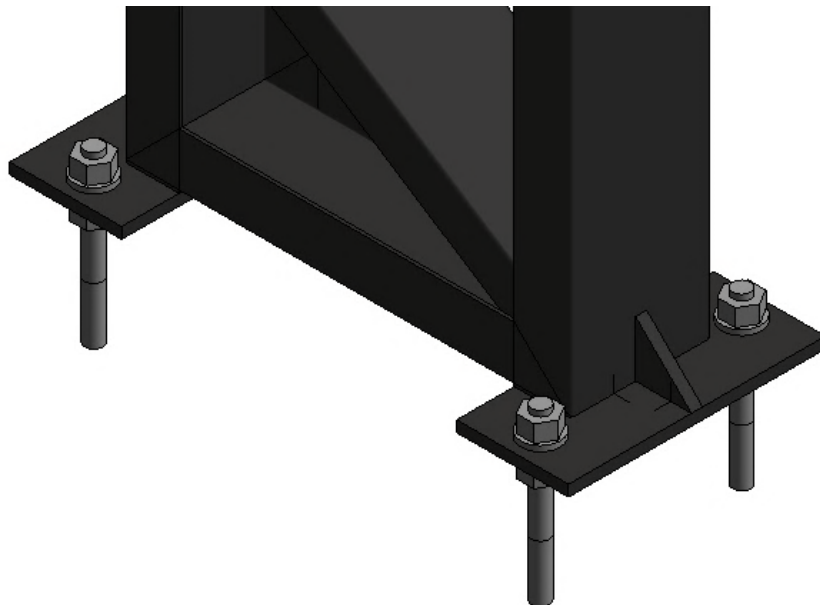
Vista tridimensional da ligação pilar | plinto no Revit 2020
